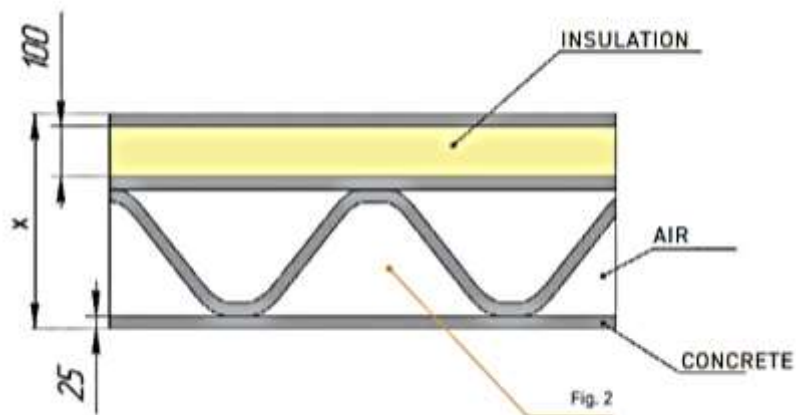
Detalle muro hueco con aislante térmico Apis Cor
